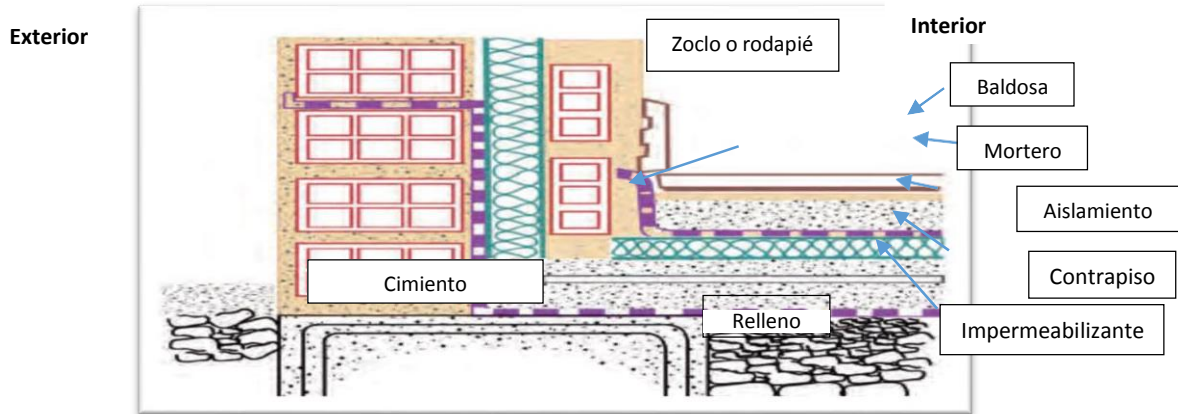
Detalle constructivo de guarnición o protección. Elaboración propia
